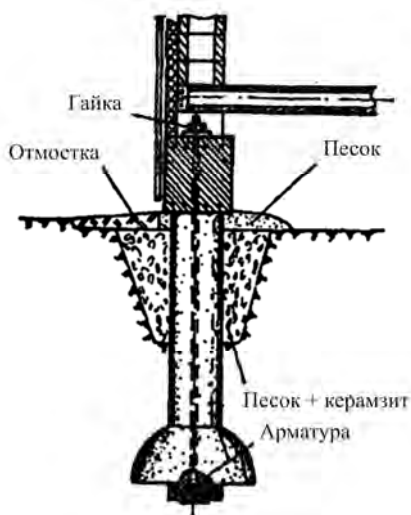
Схема столбчато-ленчатого фундамента [2]
